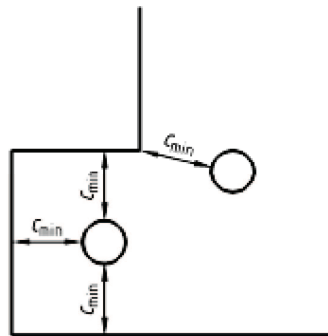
Erforderliches Mindestmaß, um eine Rissbildung im Beton von Spannbetonbalken zu verhindern
